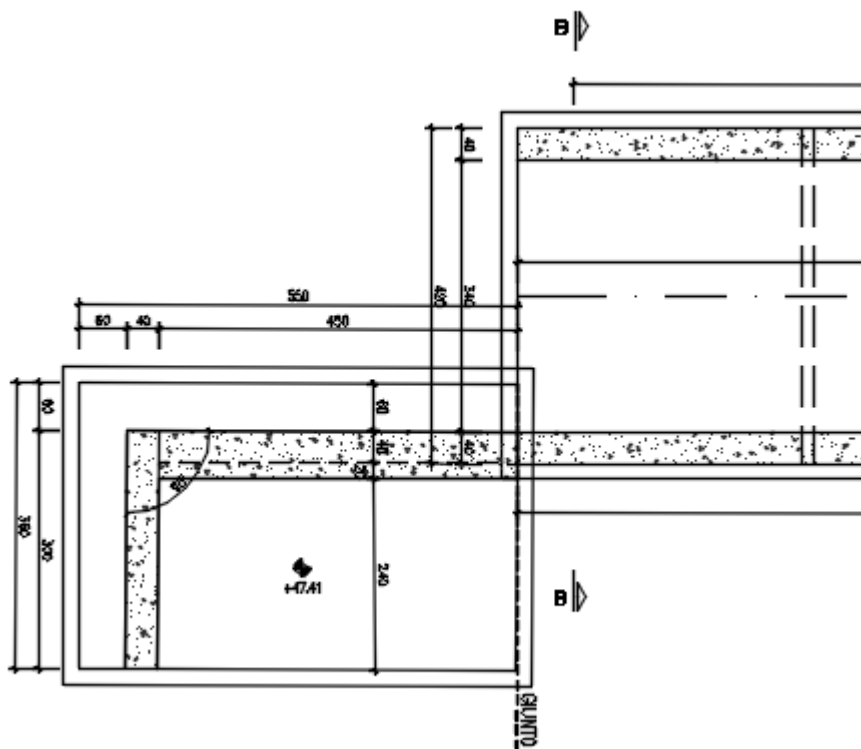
Pianta del muro di estremità del sottopasso IN02
